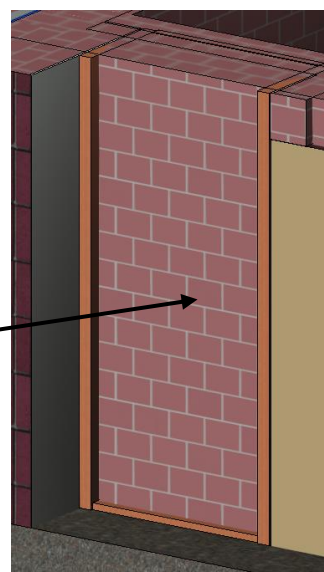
3D model zobrazující fázi rekonstrukce s filtrem fáze předchozí konstrukce + demolovaný stav
